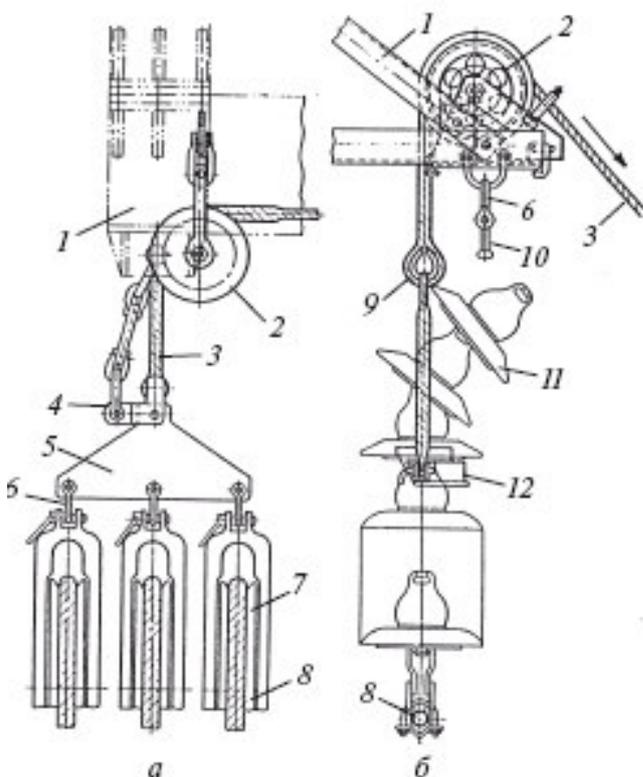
Схема подъема монтажного подвеса с проводами ВЛ 500 кВ (а) и подъема гирлянды изоляторов с проводами ВЛ 220 кВ (б): 1 – траверса опоры; 2 – блок; 3 – такелажный трос; 4 – монтажное промежуточное звено; 5 – коромысло; 6 – скоба СК-8; 7 – раскаточный ролик; 8 – провод; 9 – коуш; 10 – серьга СР-6; 11 – изолятор; 12 – захват
